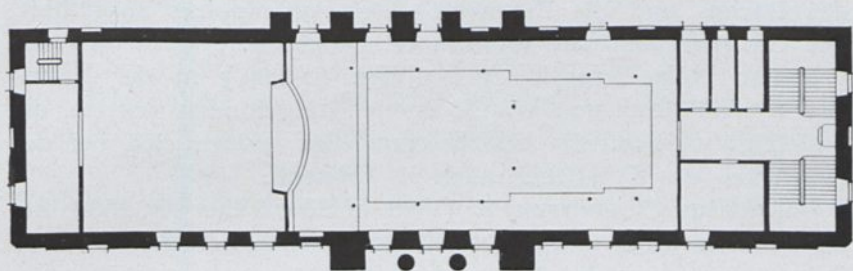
Theater in Glogau. Grundriß im Hauptgeschoß M. 1:400
